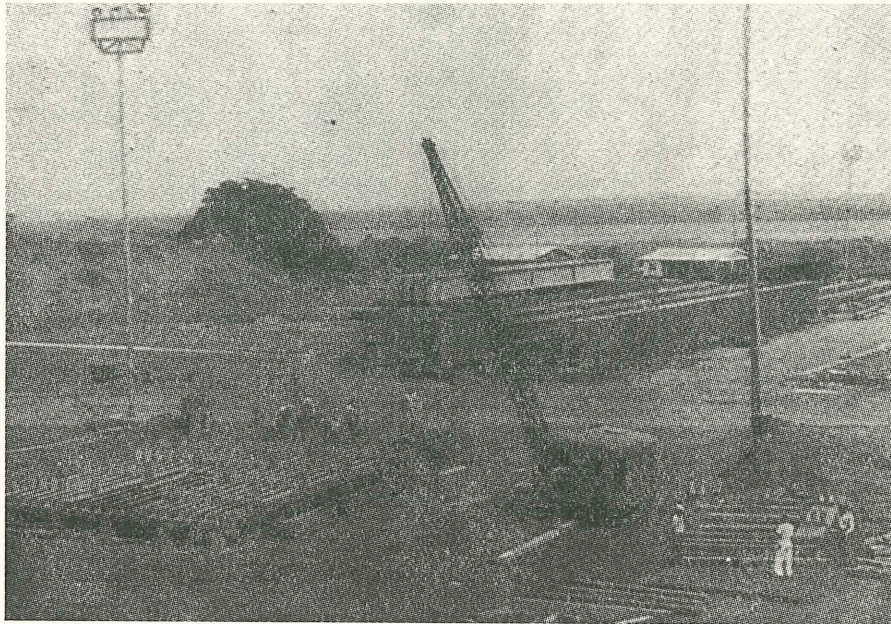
Dos sectores del taller de prefabricación de las vigas pretensadas
